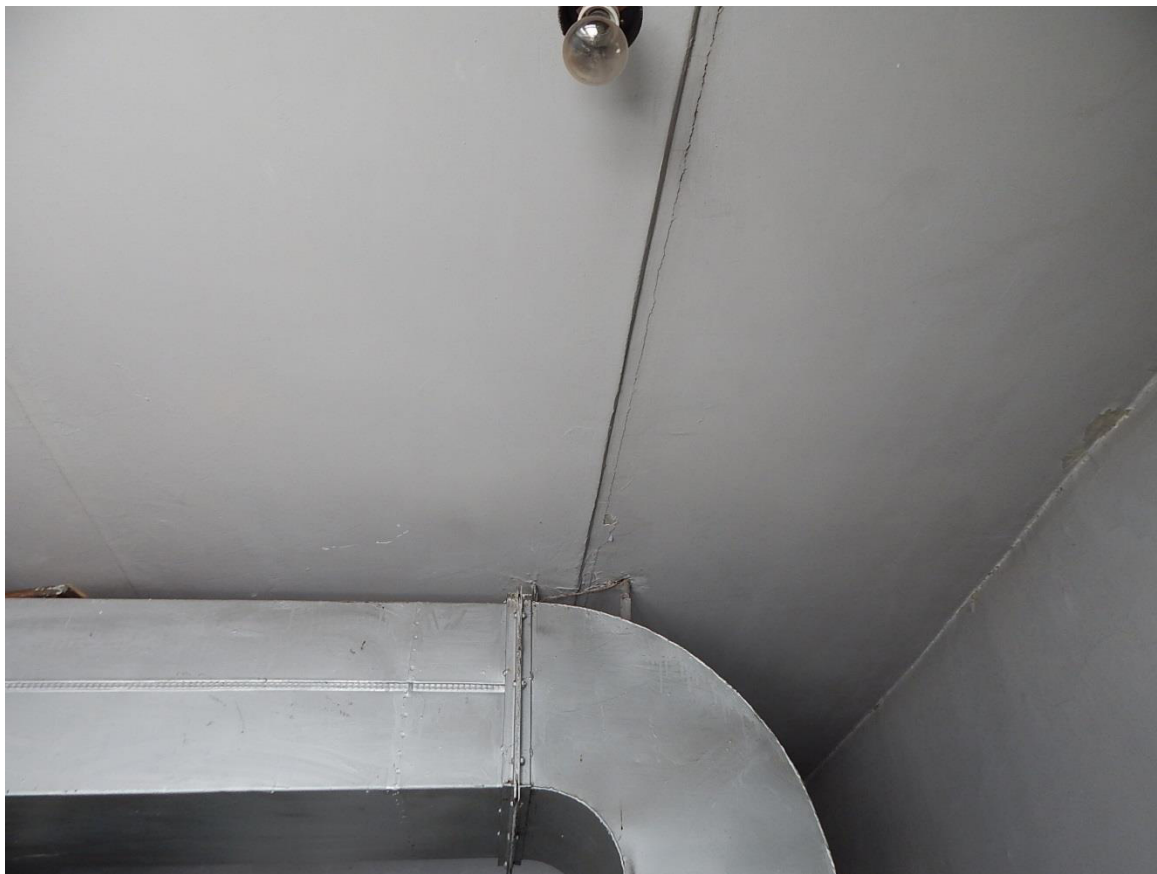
Внешний вид плит покрытия в помещении вентиляционной
